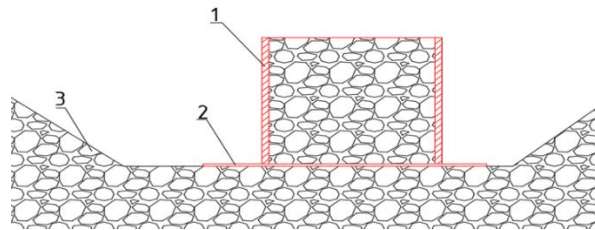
Схема обладнання для випробувань: 1 – циліндр; 2 – металева пластина; 3 – щебенева подушка
